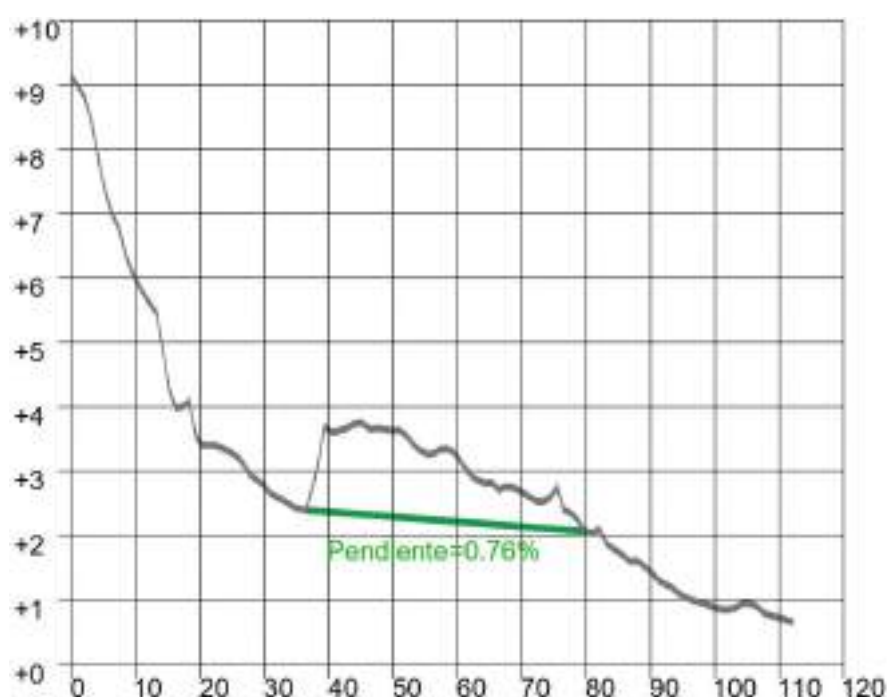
Perfil longitudinal del trazado proyectado para la Cañada Pichuaga
